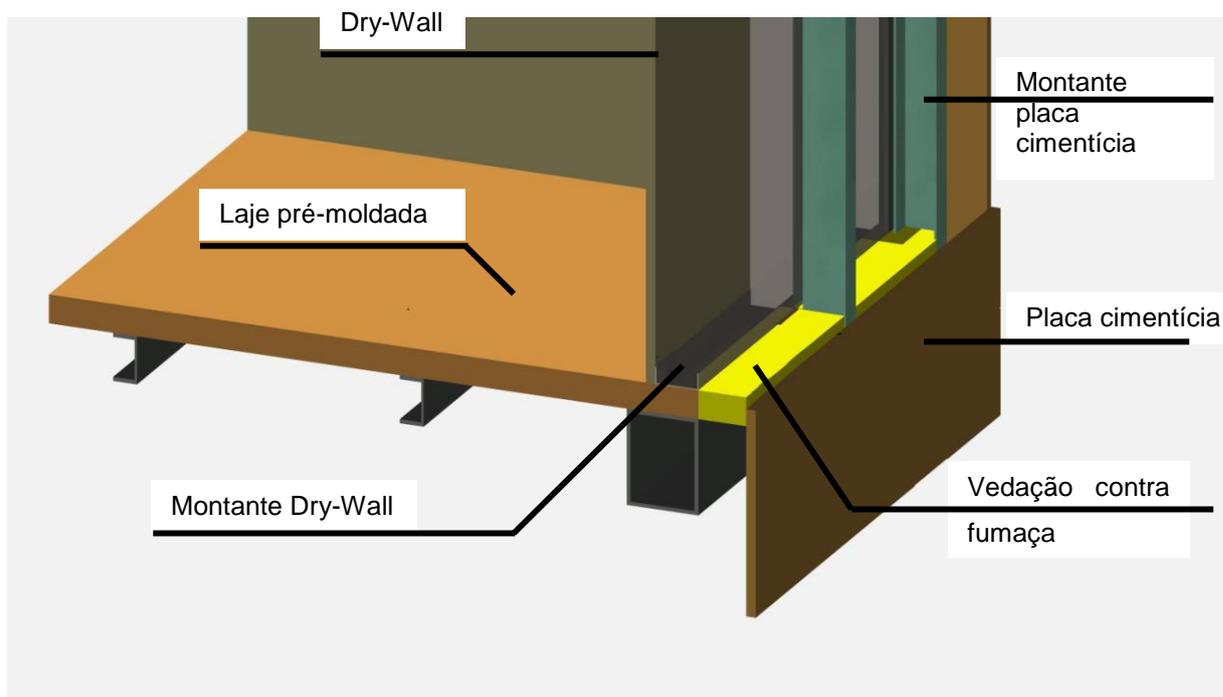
Detalhe da proteção contra-fumaça instalada entre a placa cimentícia e face externa da laje pré-moldada.
